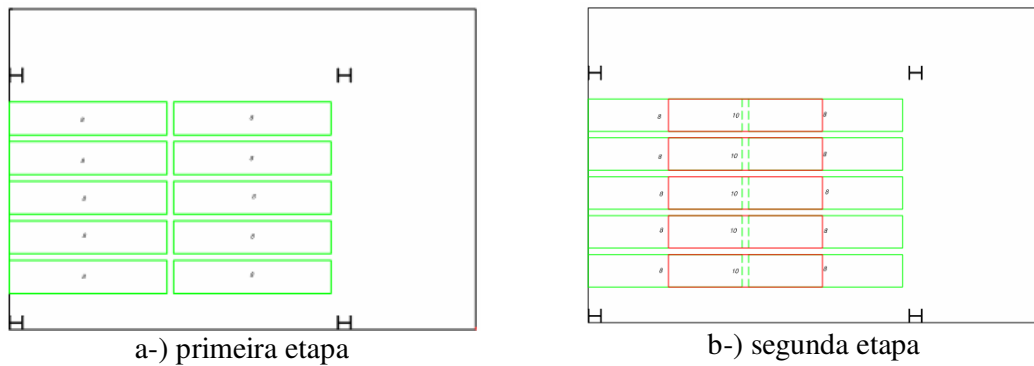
Esquema da primeira e segunda etapas de carregamento distribuído
